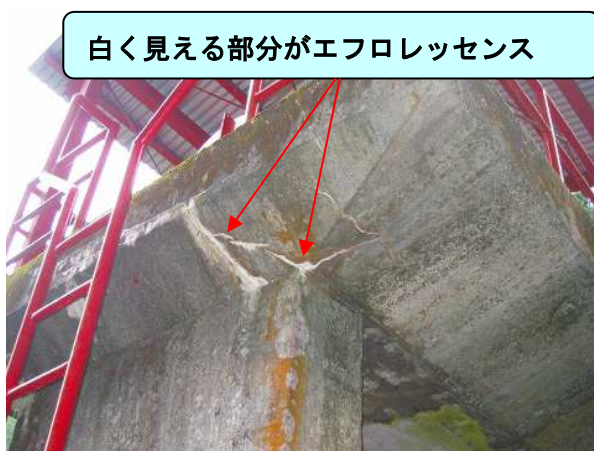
ひび割れ部のエフロレッセンス
